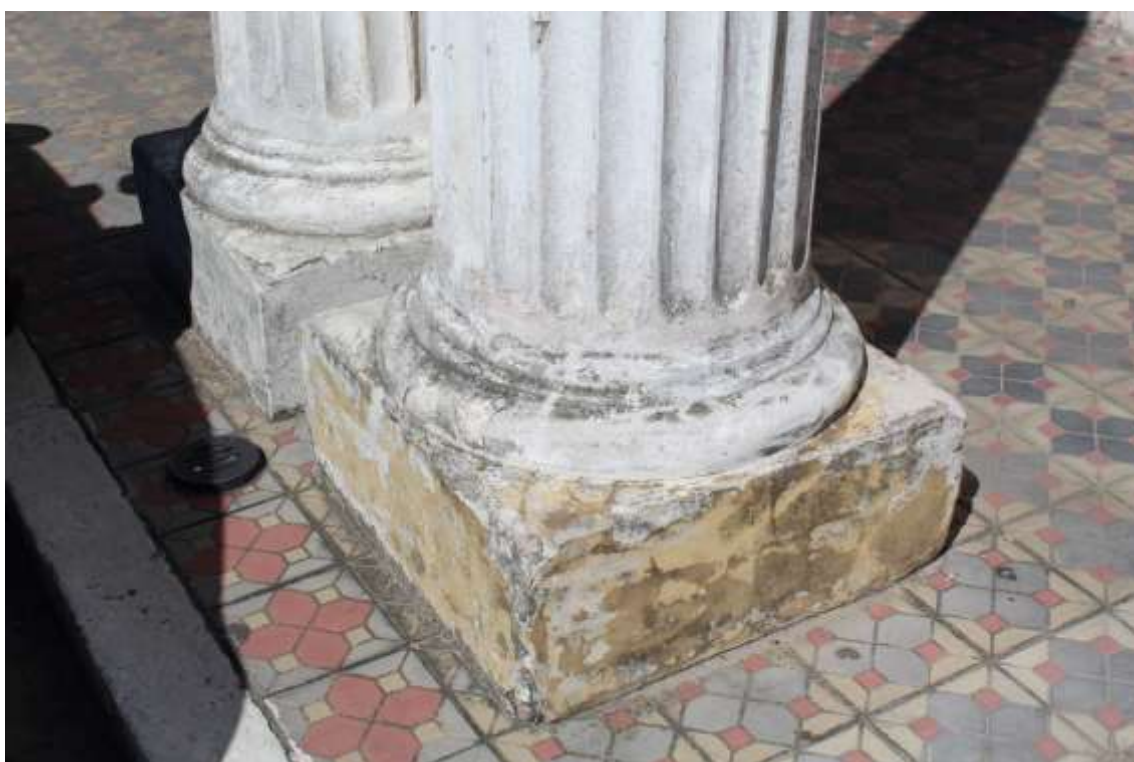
= FACHADA NORDESTE: base dos pilares com revestimento danificado
